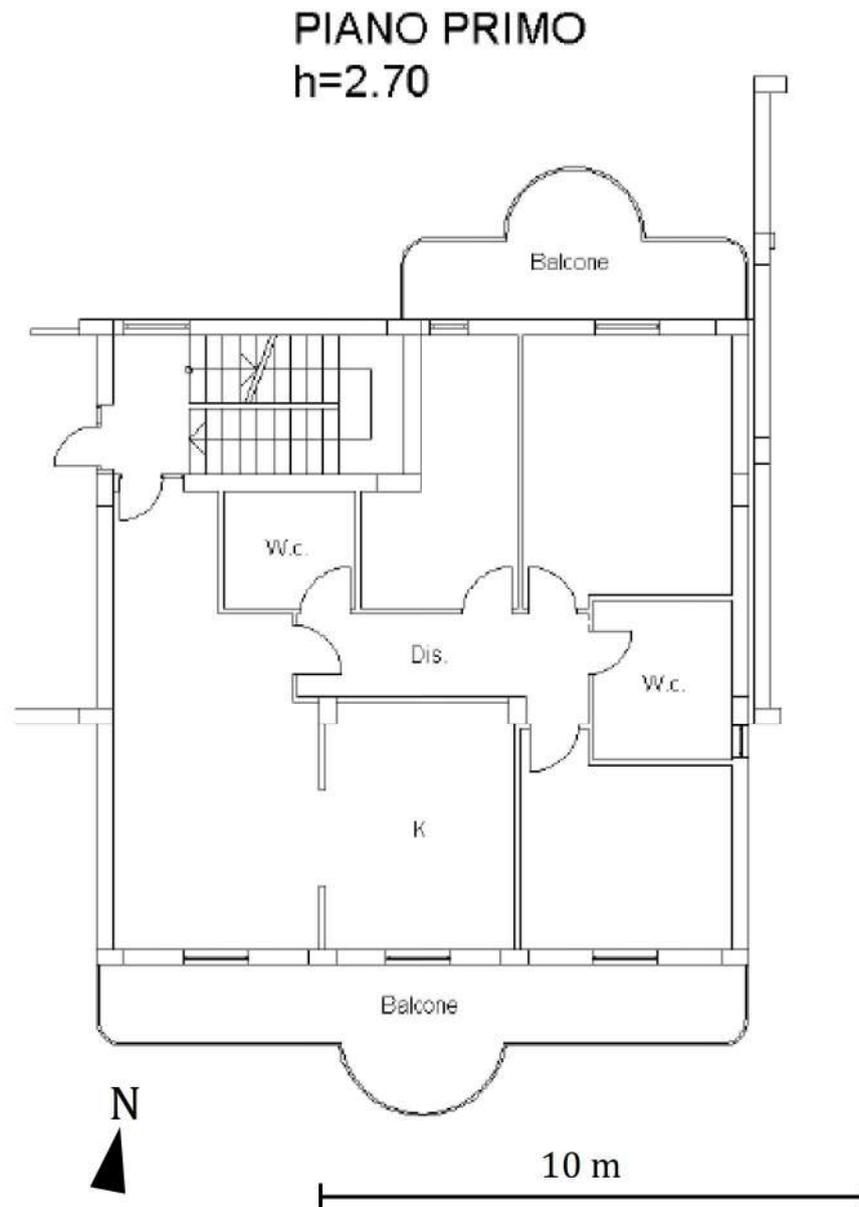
Estratto Planimetria Catastale - Foglio ■ Part. ■ Sub ■ - Piano 1° (appartamento)
